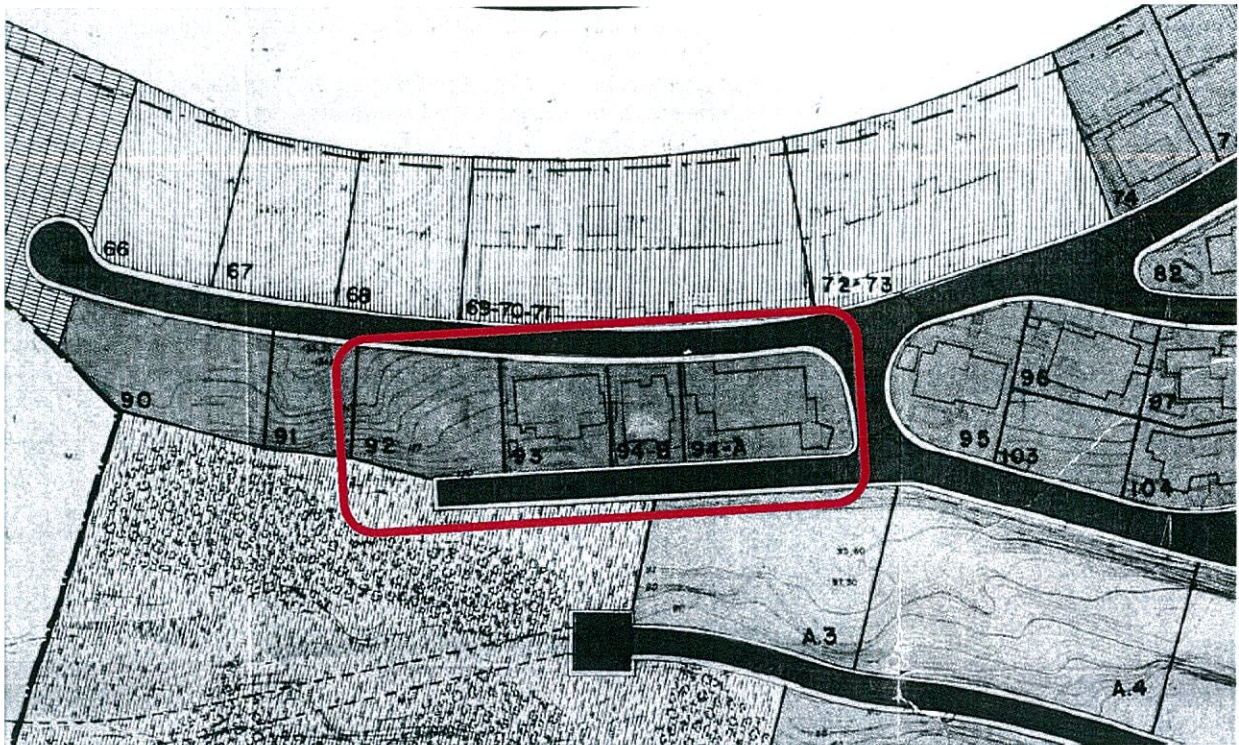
Detalle de parcelas según plano del PERI Radazul
